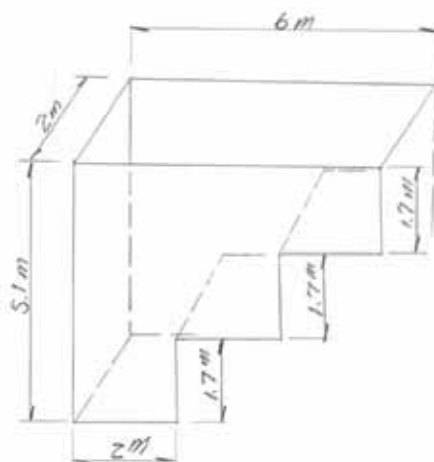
Profil du puits d'essai (Forme d'excavation)
